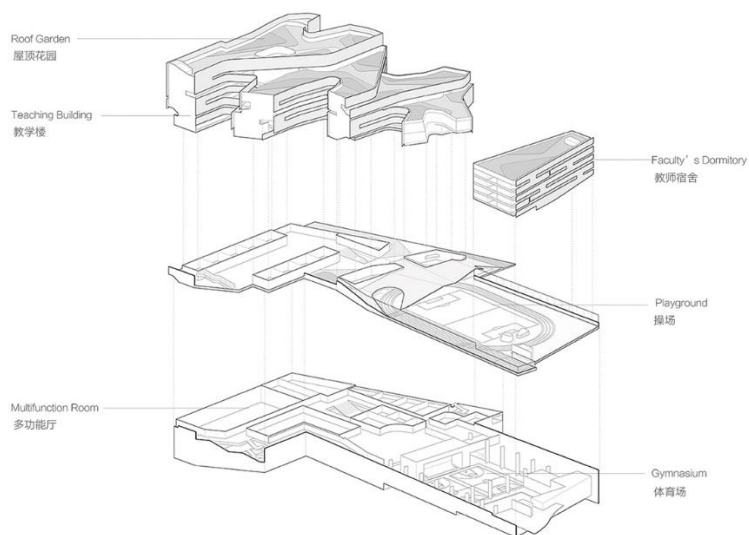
Аксонометрична схема планування будівлі [25]
